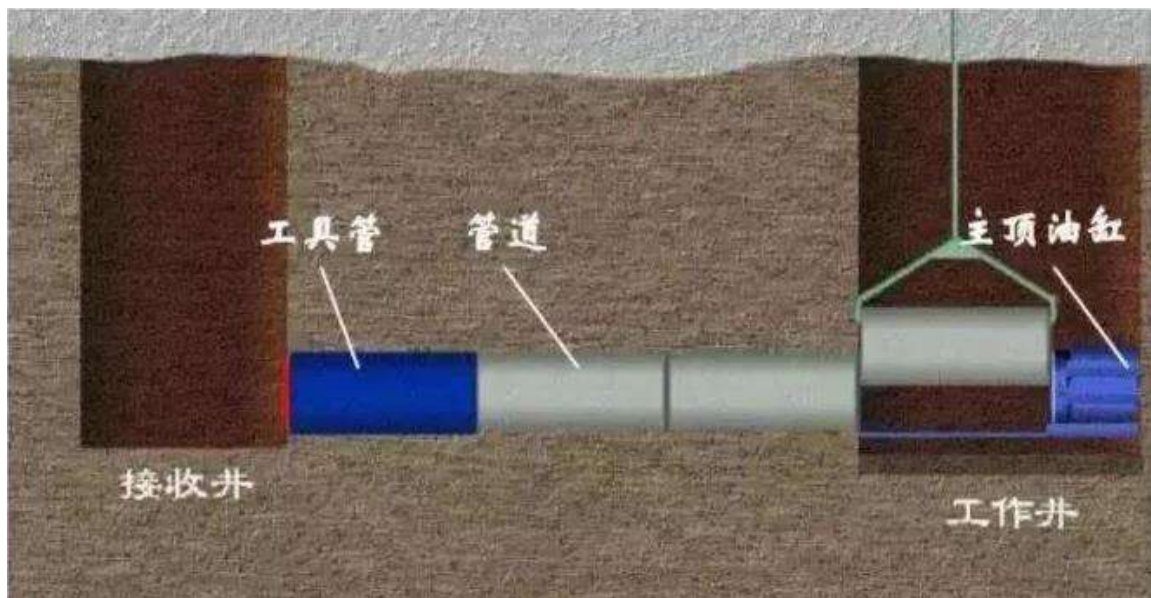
顶管穿越施工钻导向孔过程断面示意图
